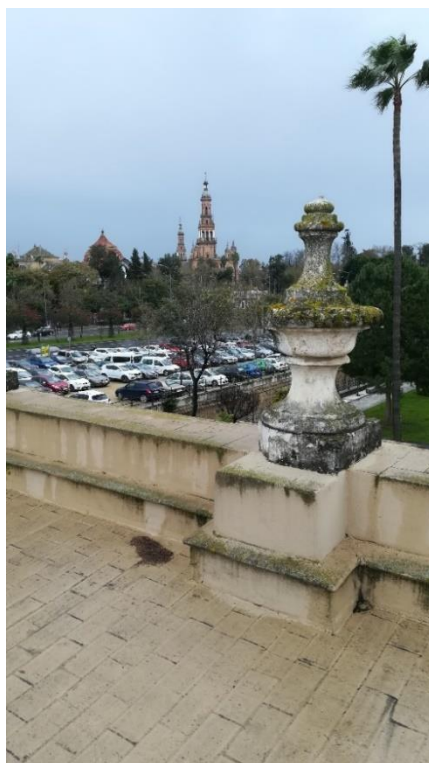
Elemento decorativo en el antepecho de la cubierta de la capilla. Fuente: Elaboración propia
